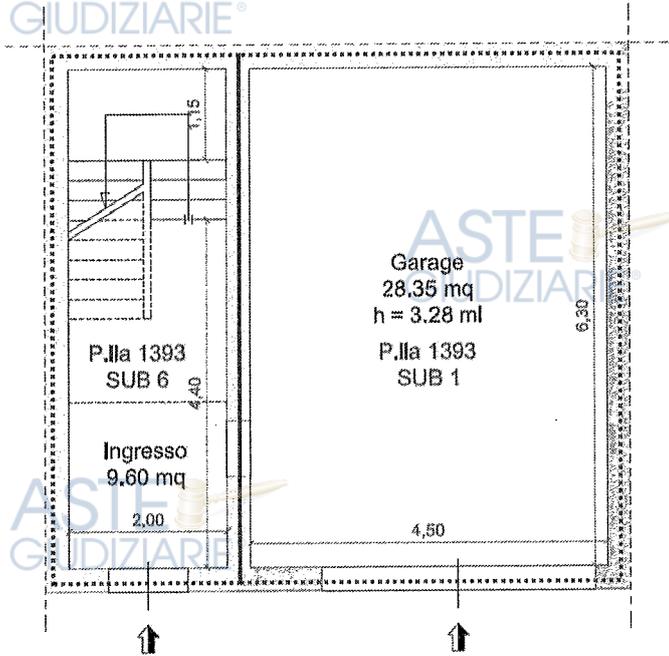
Planimetria Stato di Fatto Foglio 47, p.lla 1393, sub 1-6 - Piano Terra
